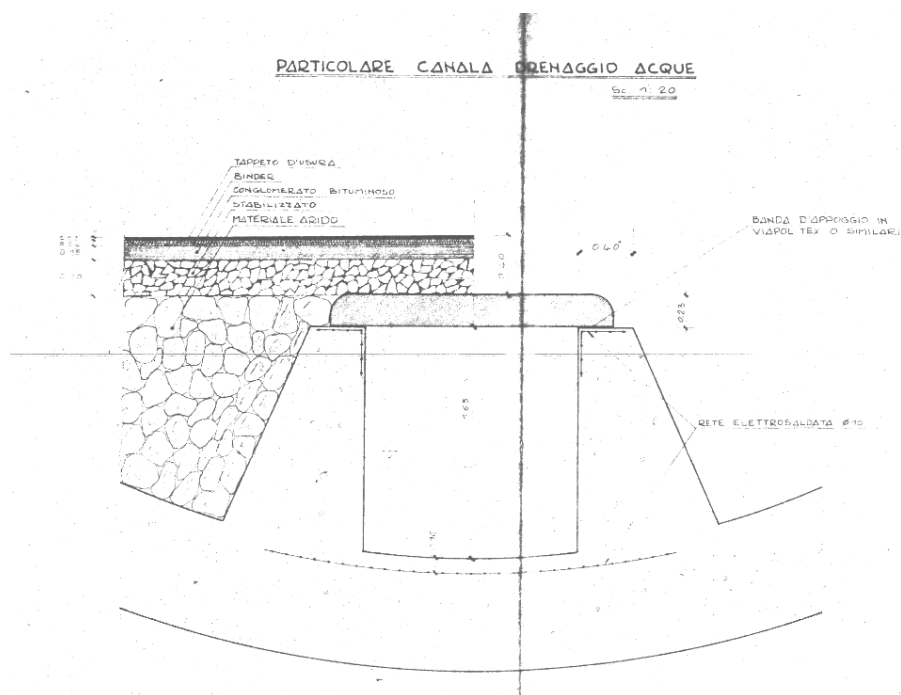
Immissioni distribuite lungo la canala di raccolta dei drenaggi posta in mezzeria della sezione autostradale
